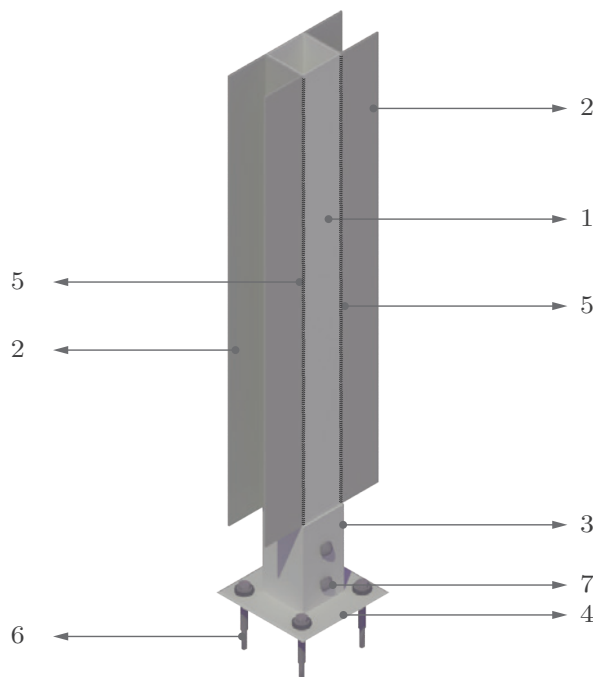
Detalle de la conexión de perfiles C a la columna del habitáculo Modular Emergency Plant. Fuente y elaboración: Autores.
